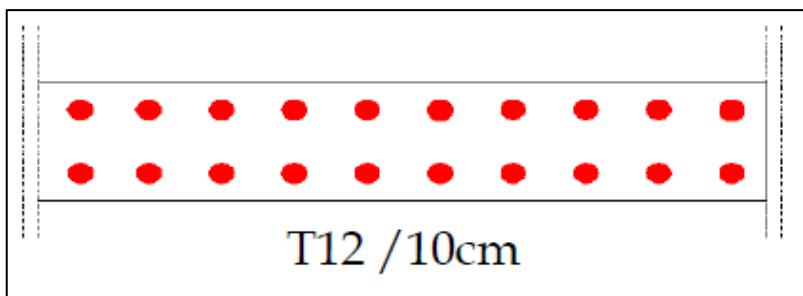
ferraillage de mur de contreventement en béton armé (20 cm)
